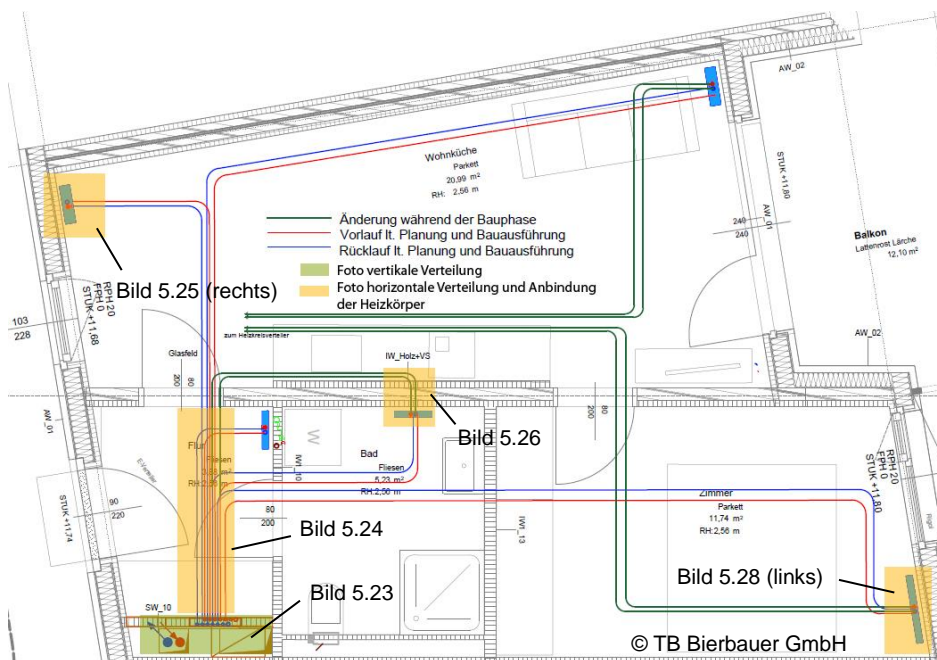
Grundrissdarstellung der Heizungsinstallation in Wohnung 2 im 1. OG
